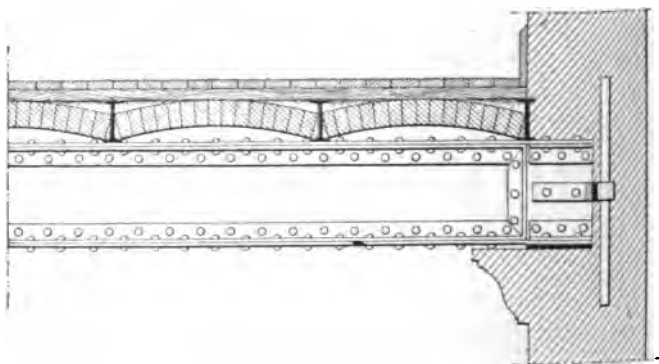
Plancher en fer dont les solives sont directement placées sur les poutres.
